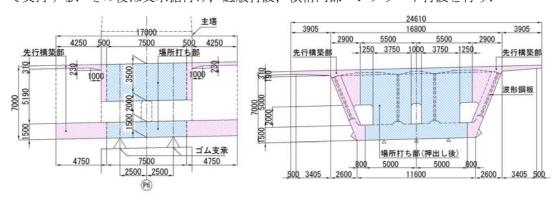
P6 柱頭部構造図 (左:側面図, 右:断面図(供用時 4 車線断面))
